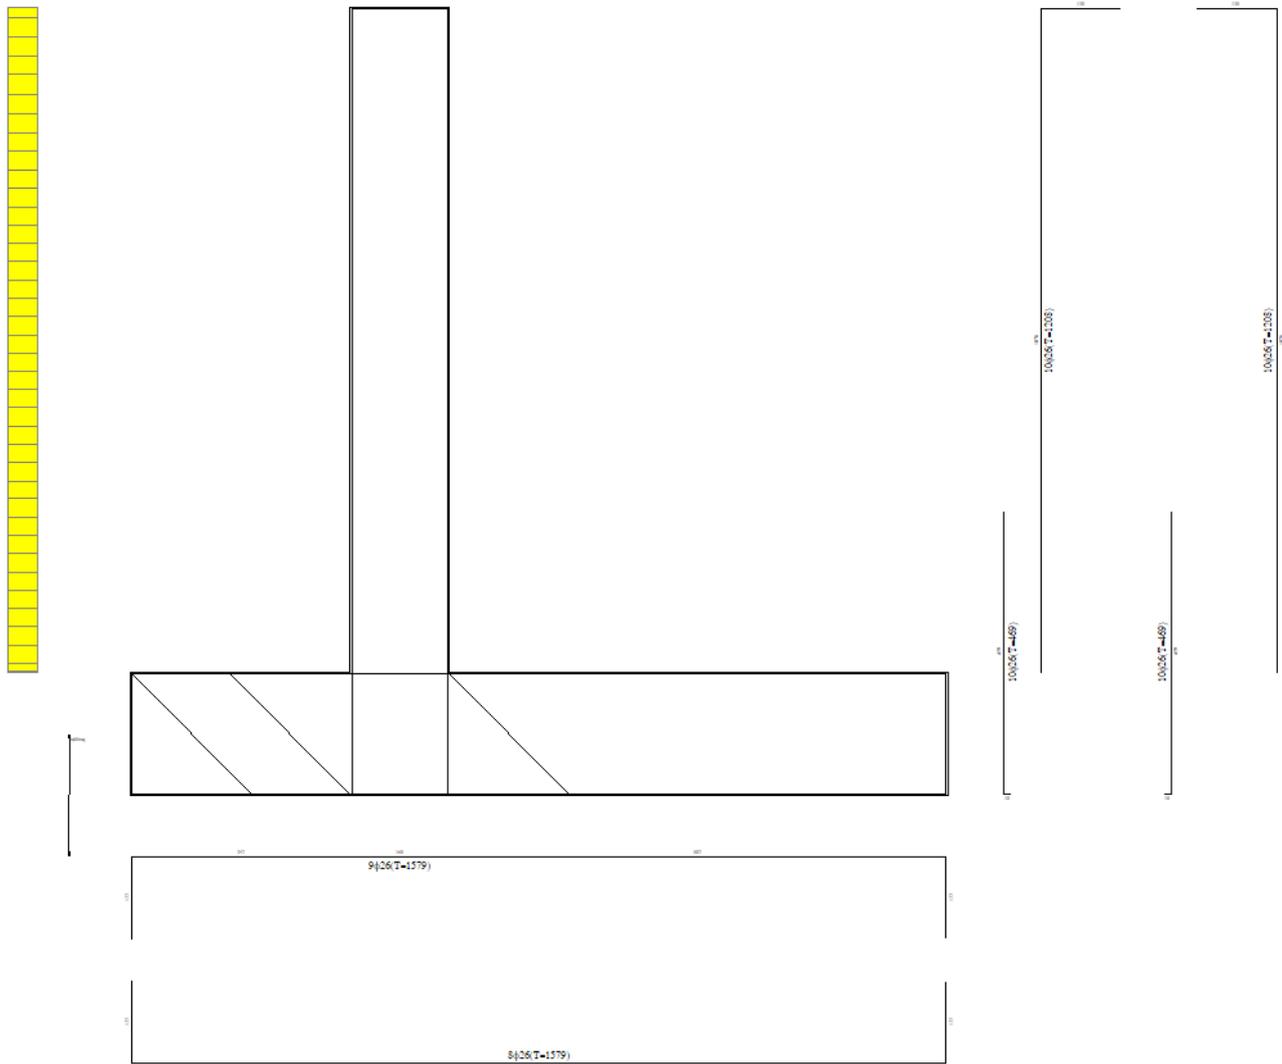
Sezione trasversale Spalla- Armatura
